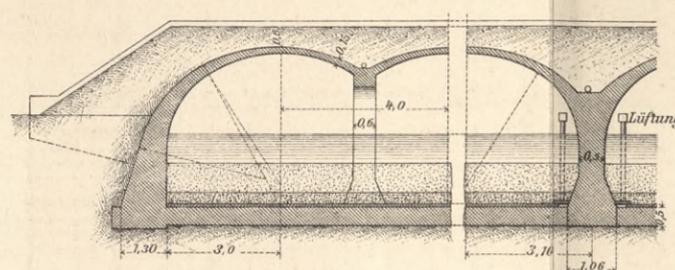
<sup>c</sup> Schnitt C-D. M.1:200.
